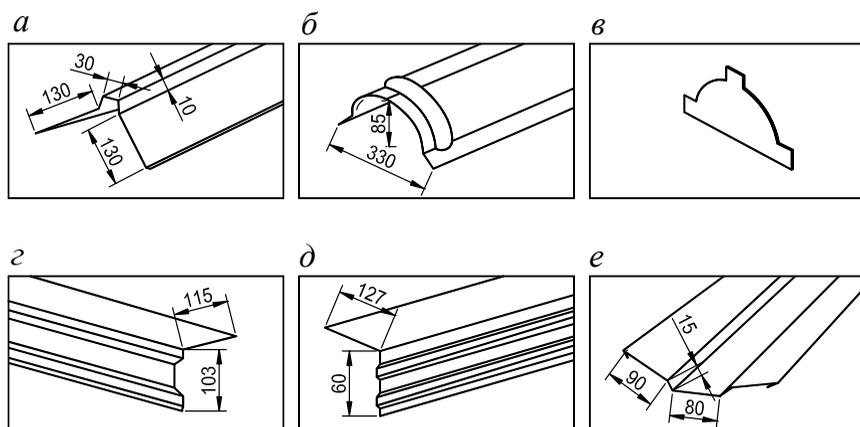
Основные конструктивные доборные элементы для кровли из металлочерепицы:
